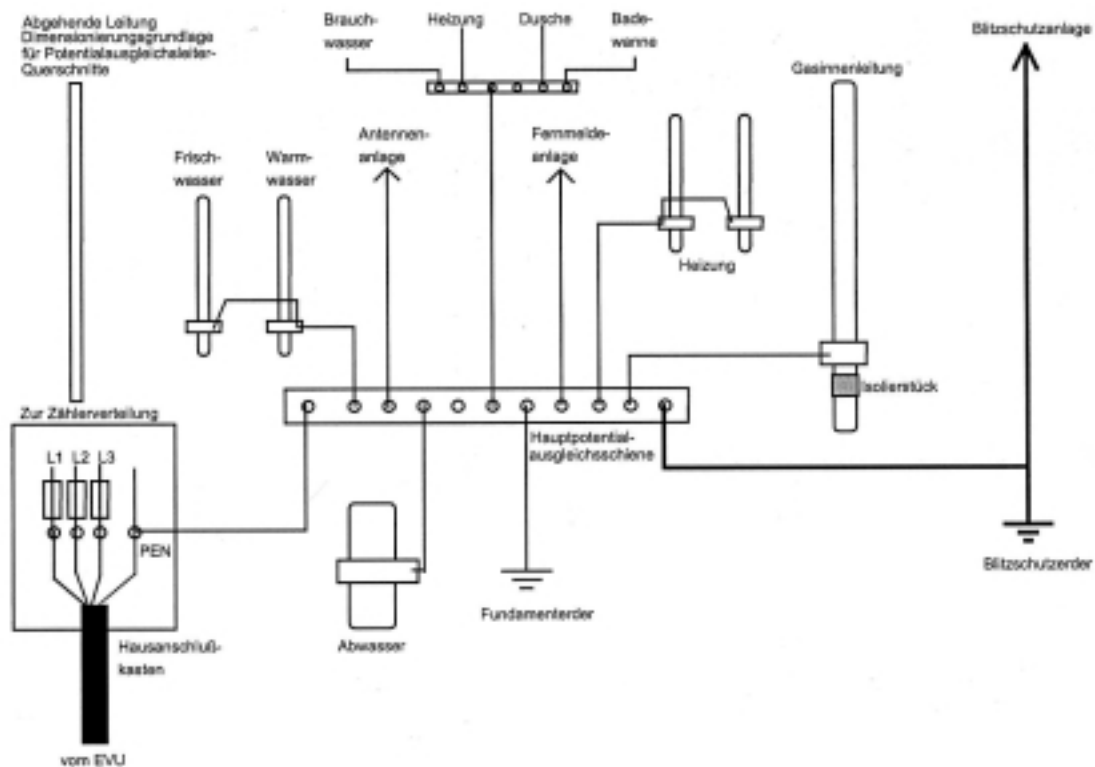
Hauptpotentialausgleich mit zusätzlichem Potentialausgleich im Badezimmerbereich
